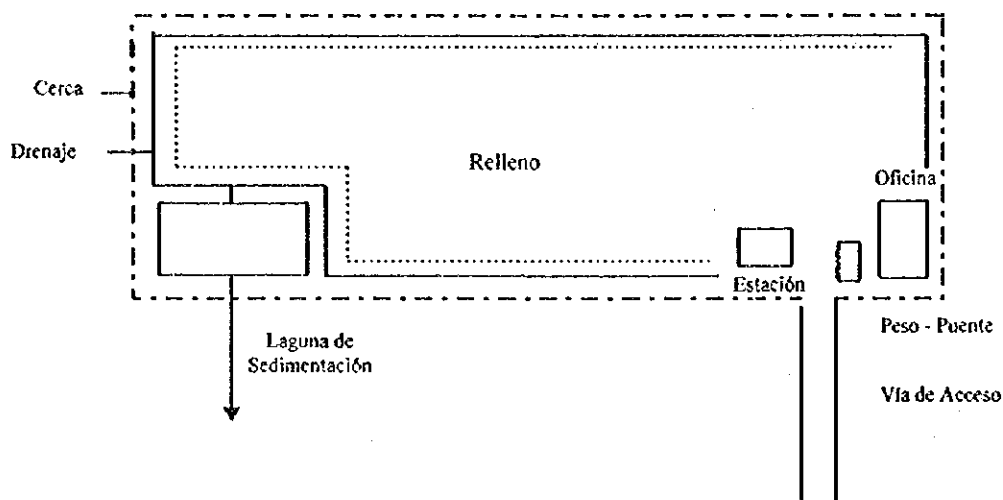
Plan Esquemático del Sitio del Relleno Sanitario
